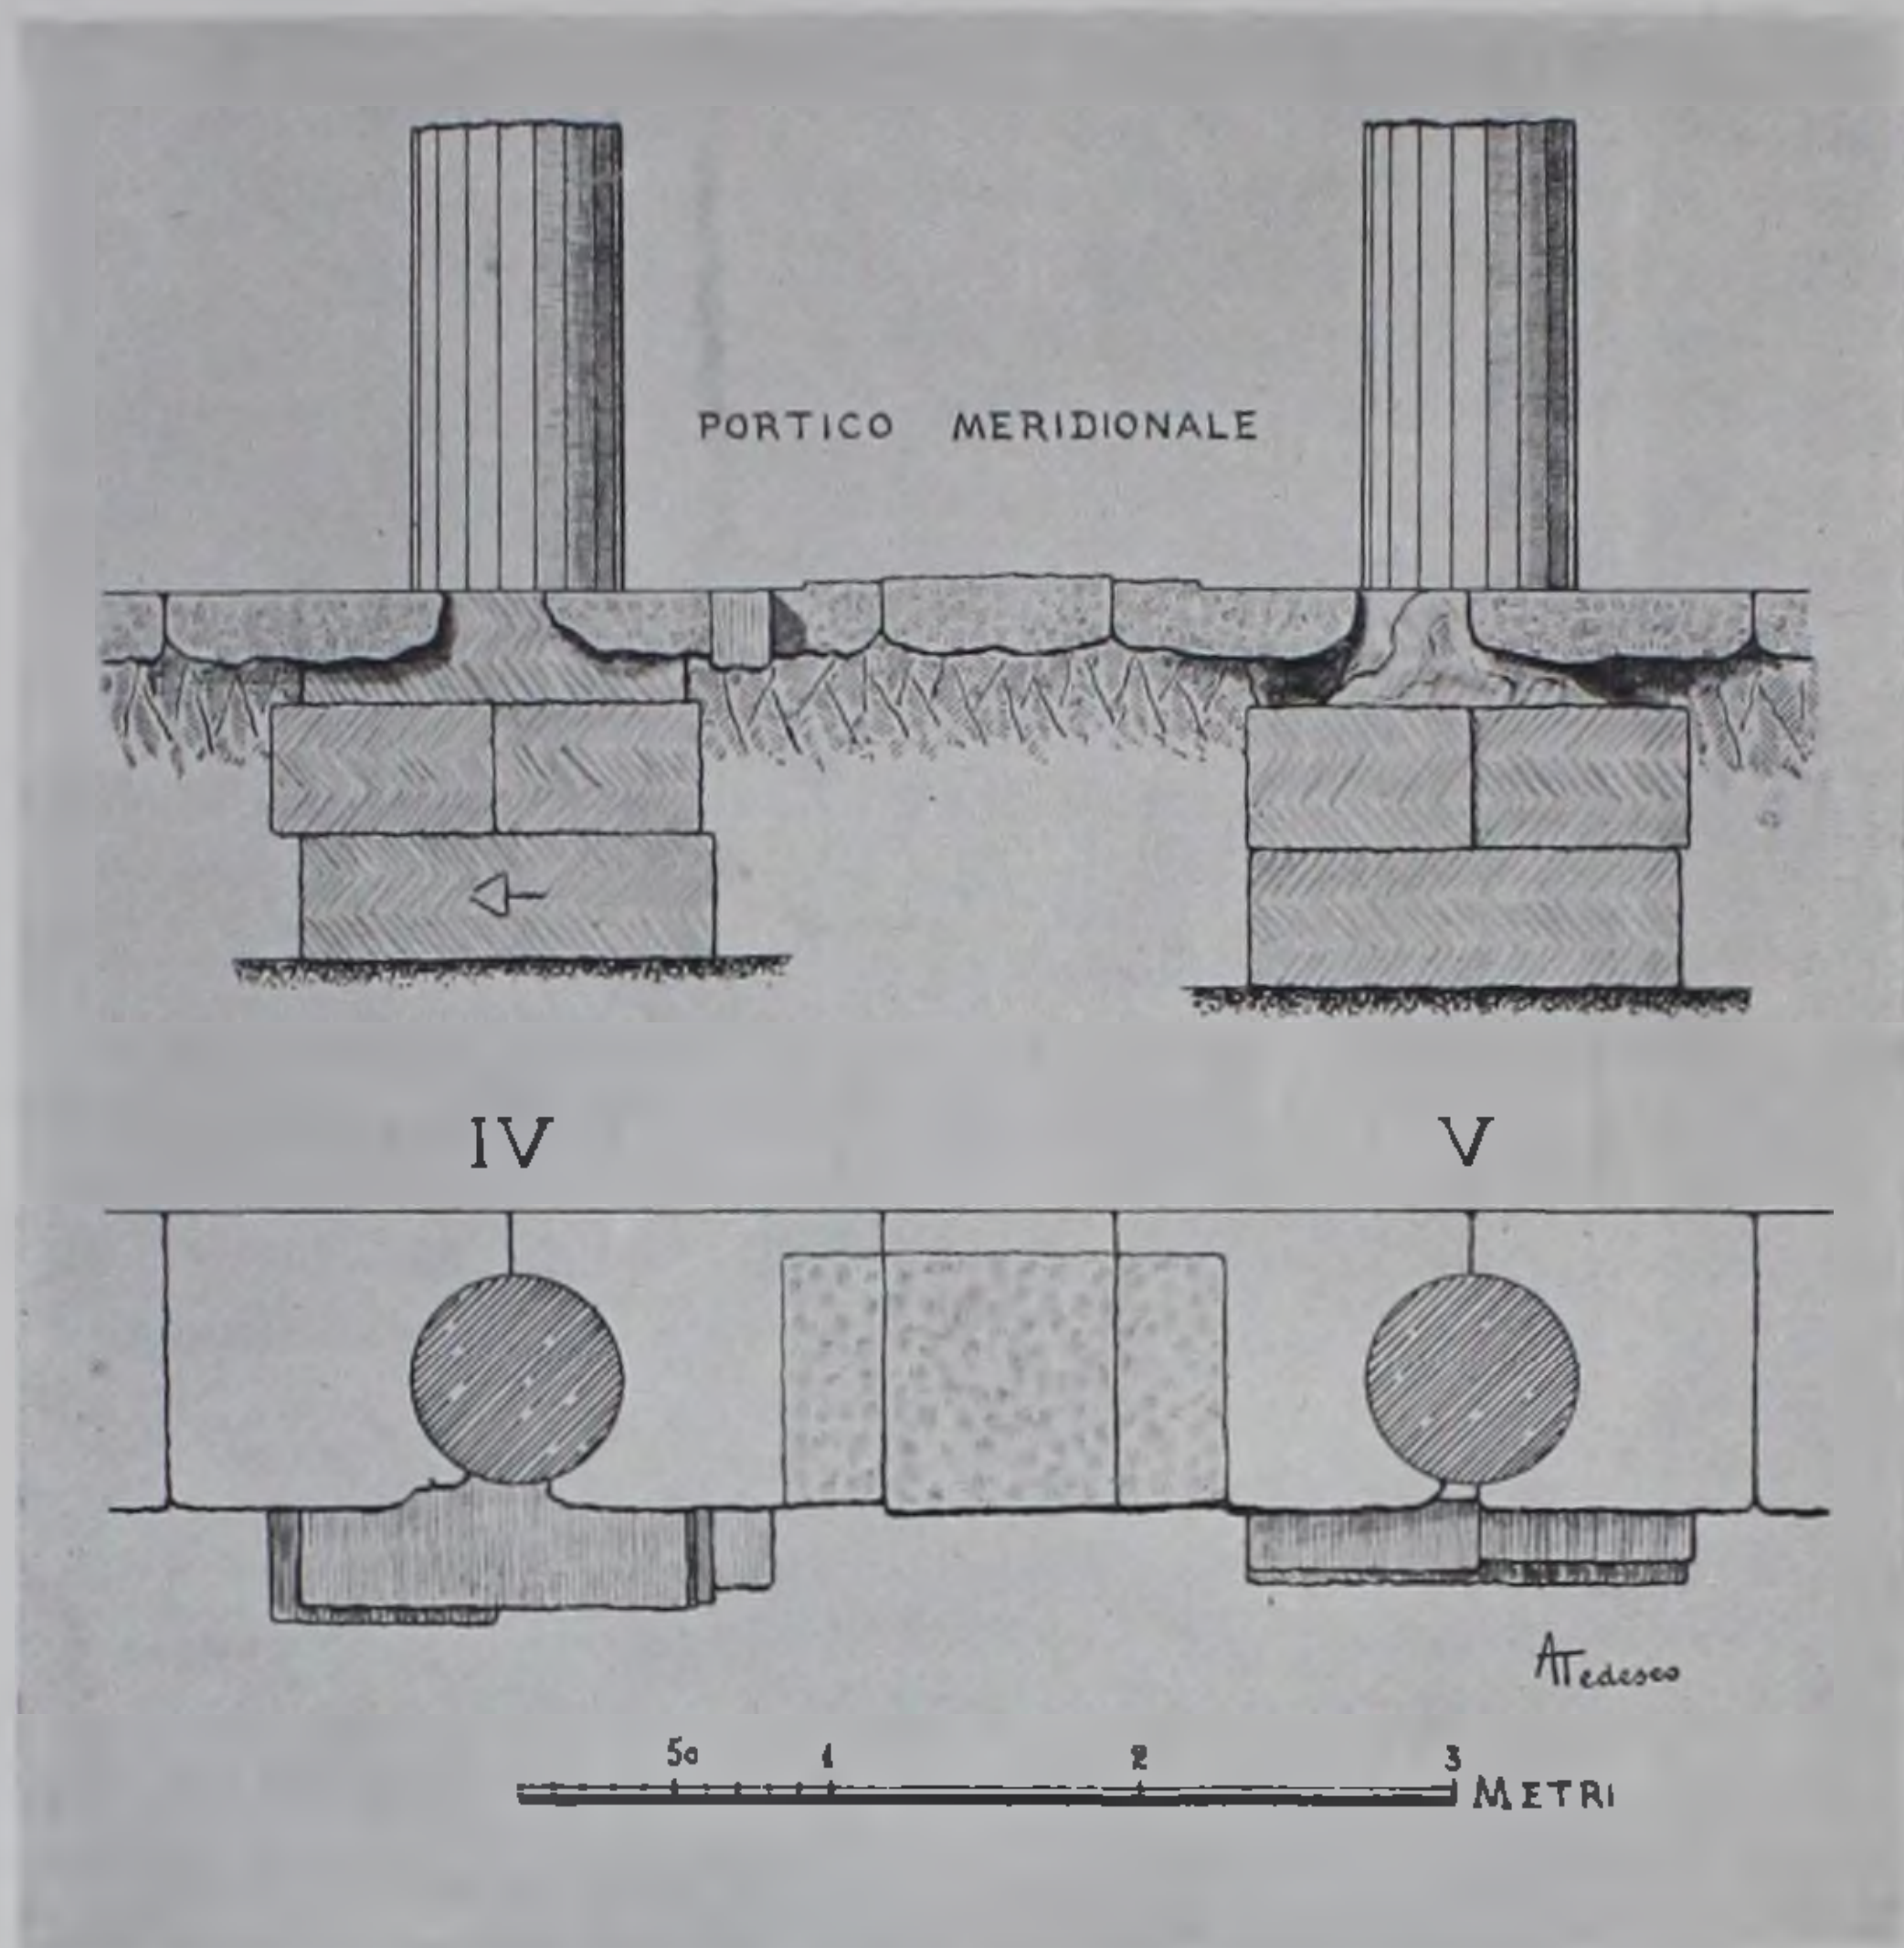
Pianta e sezione delle colonne in tufo del portico meridionale.
